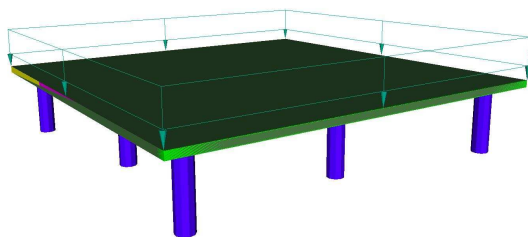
Vista espacial da estrutura com indicação de carregamentos.
